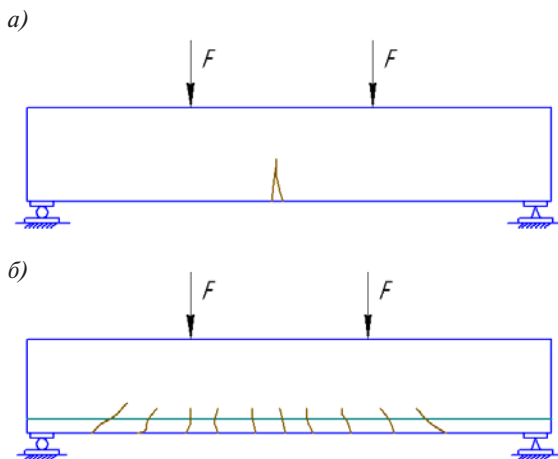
Работа бетонных армированных и неармированных балок под нагрузкой: *a* – бетонная балка; *б* – железобетонная балка
